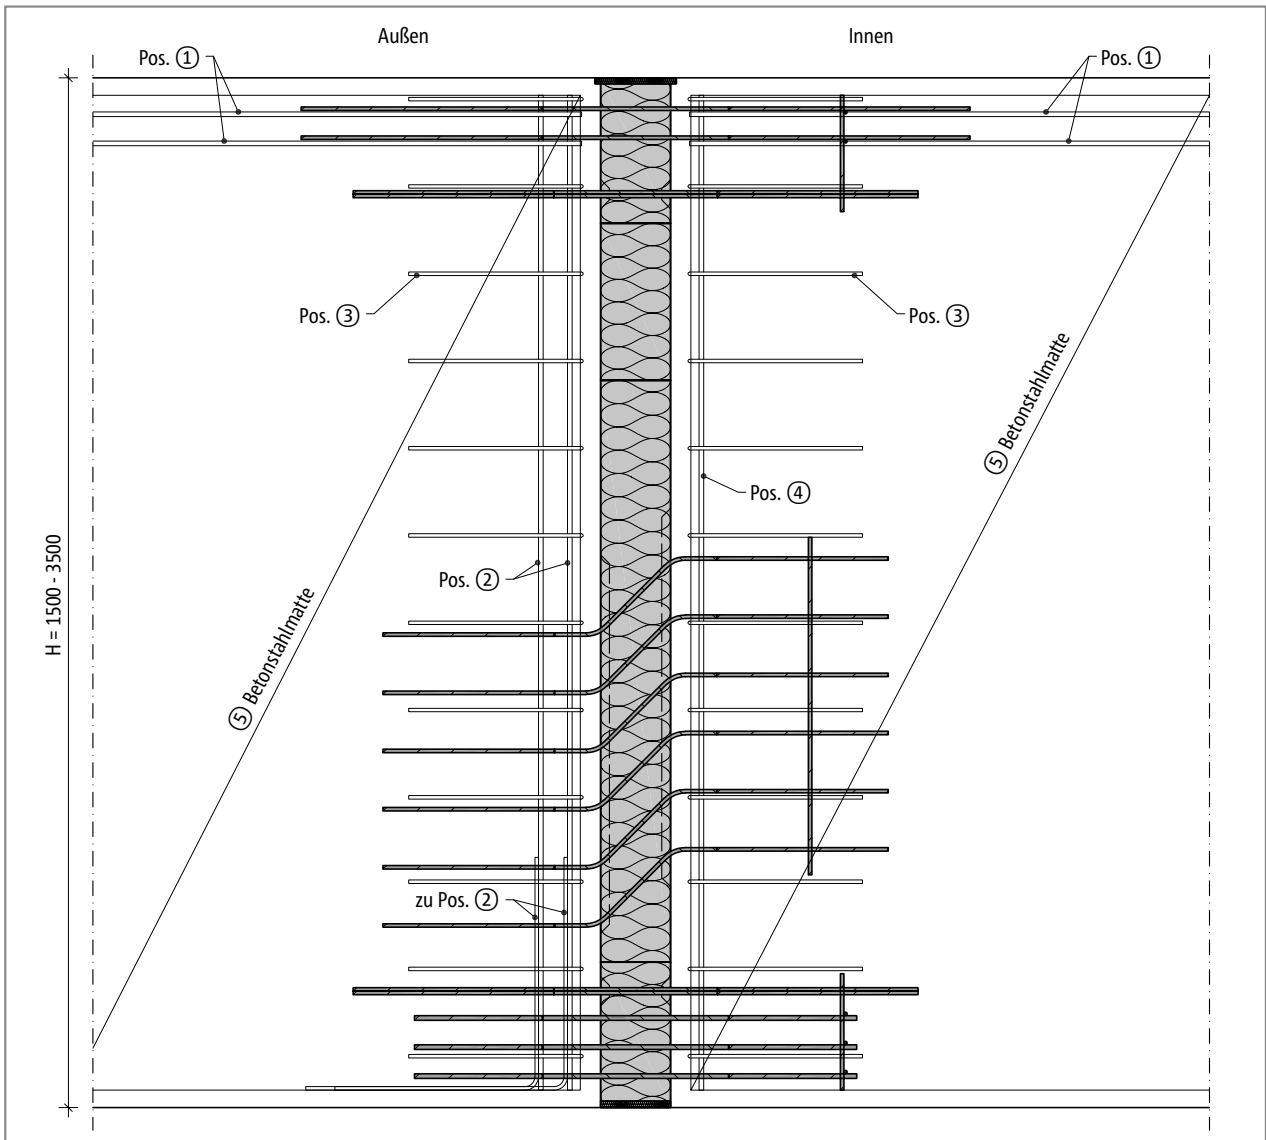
Schöck Isokorb® XT Typ W: Bauseitige Bewehrung; Schnitt
